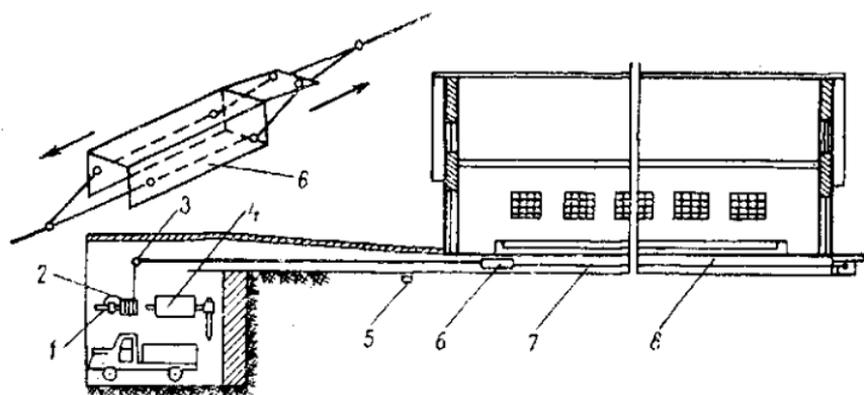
Схема канатно-скреперной установки СУ-ВИМ:
